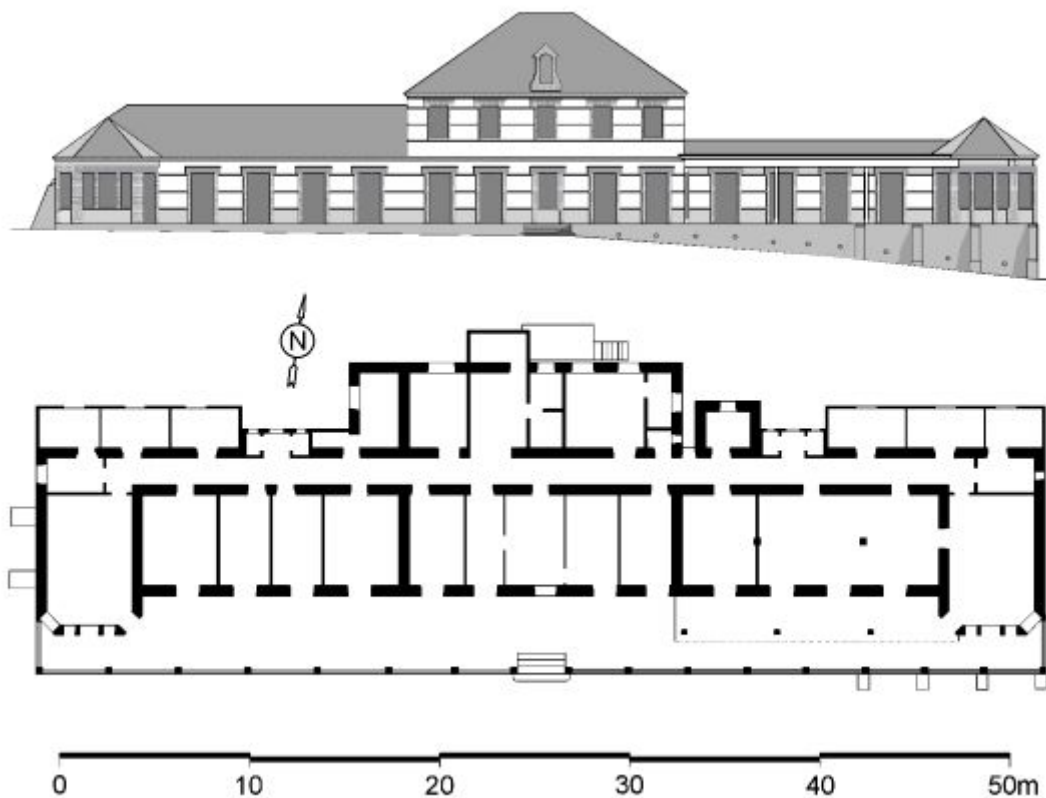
Reconstrucción de la planta y el alzado del Sanatorio de la Alfaguara, zona rebelde. Fidel Baena.
